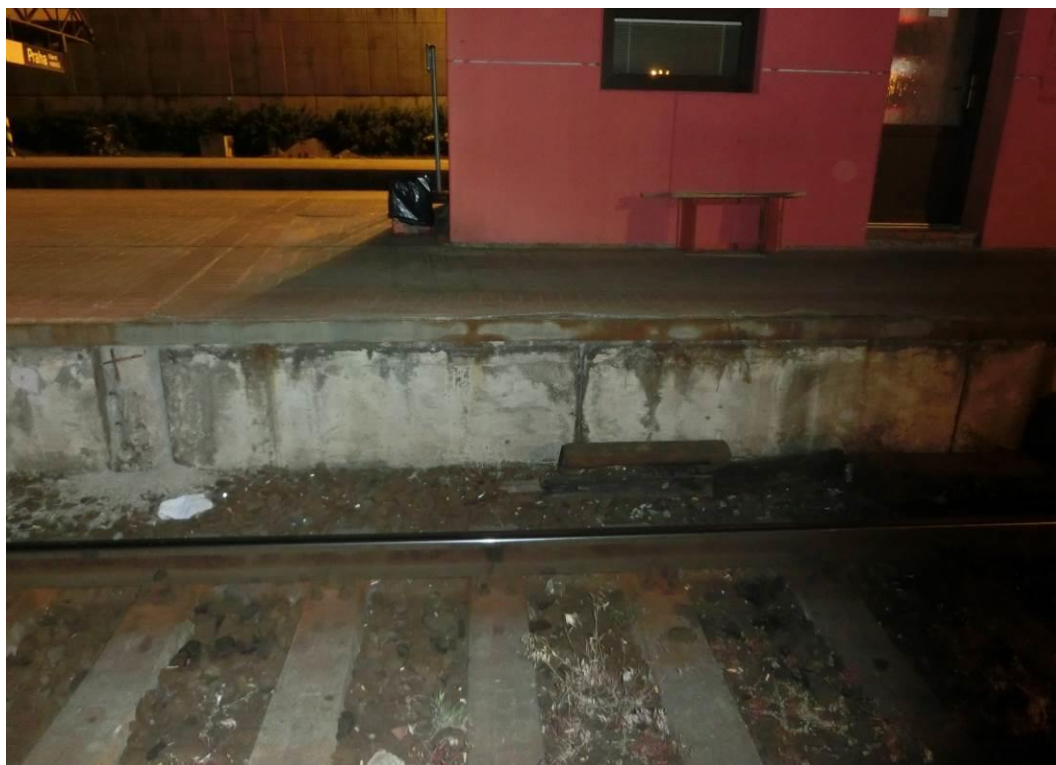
Pohled na nástupištní zídku – patrná lokální koroze výztuže, degradace krycí vrstvy betonu
